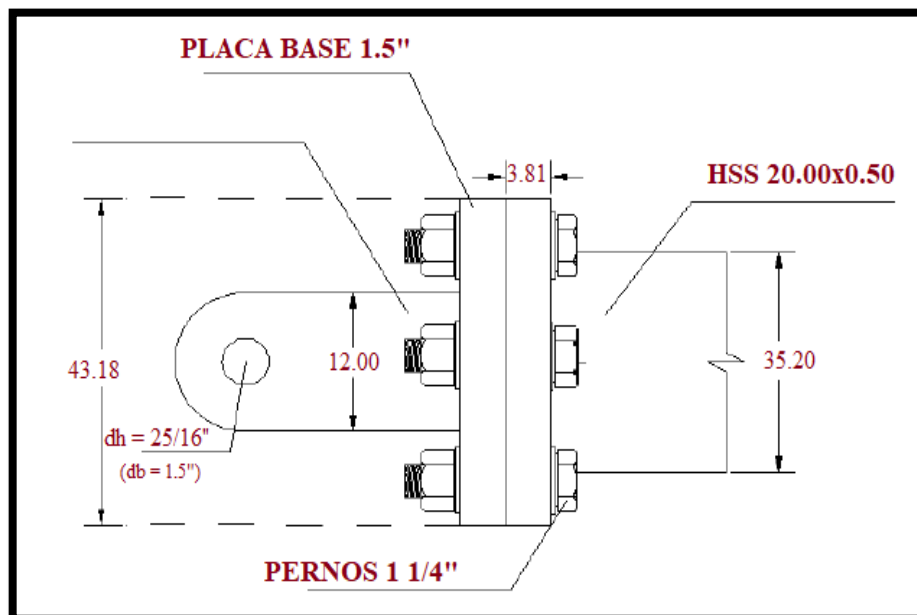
Detalle 02 Conexión brazo metálico – barra de conexión. Fuente: Propia
